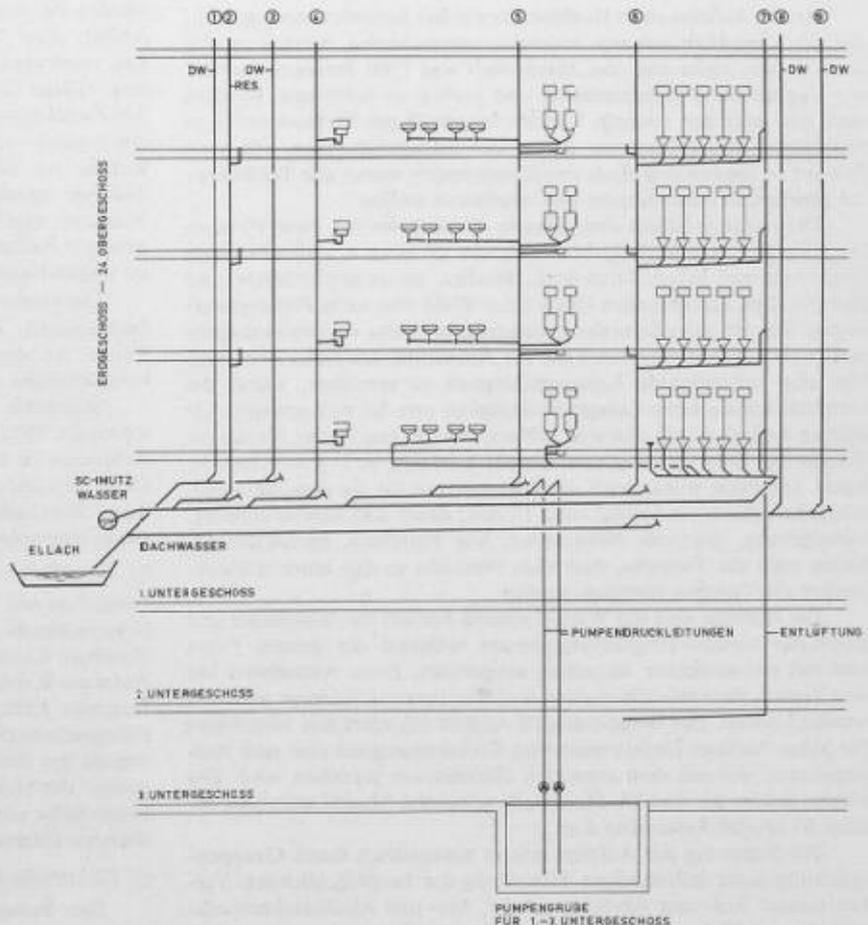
Prinzipschema der Abwasser-Abflussinstallation
